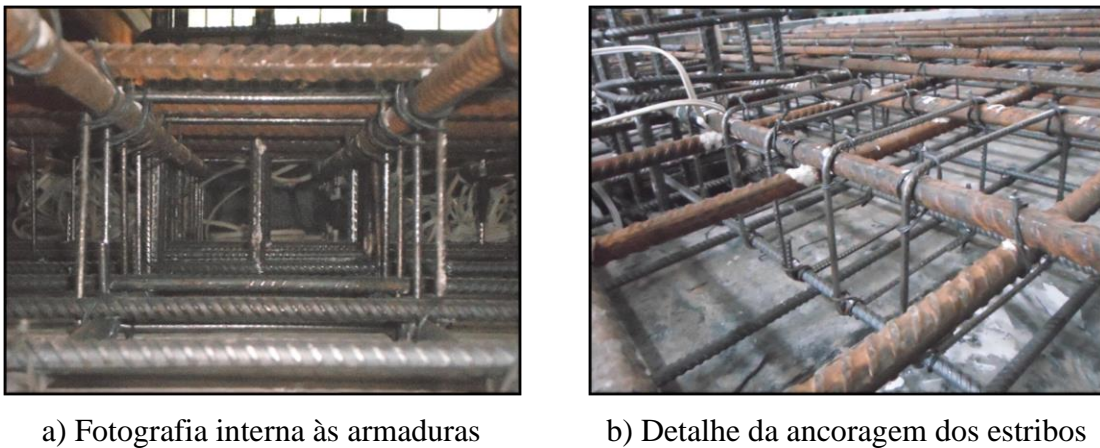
Fotografias da ancoragem dos estribos na laje FA-05
